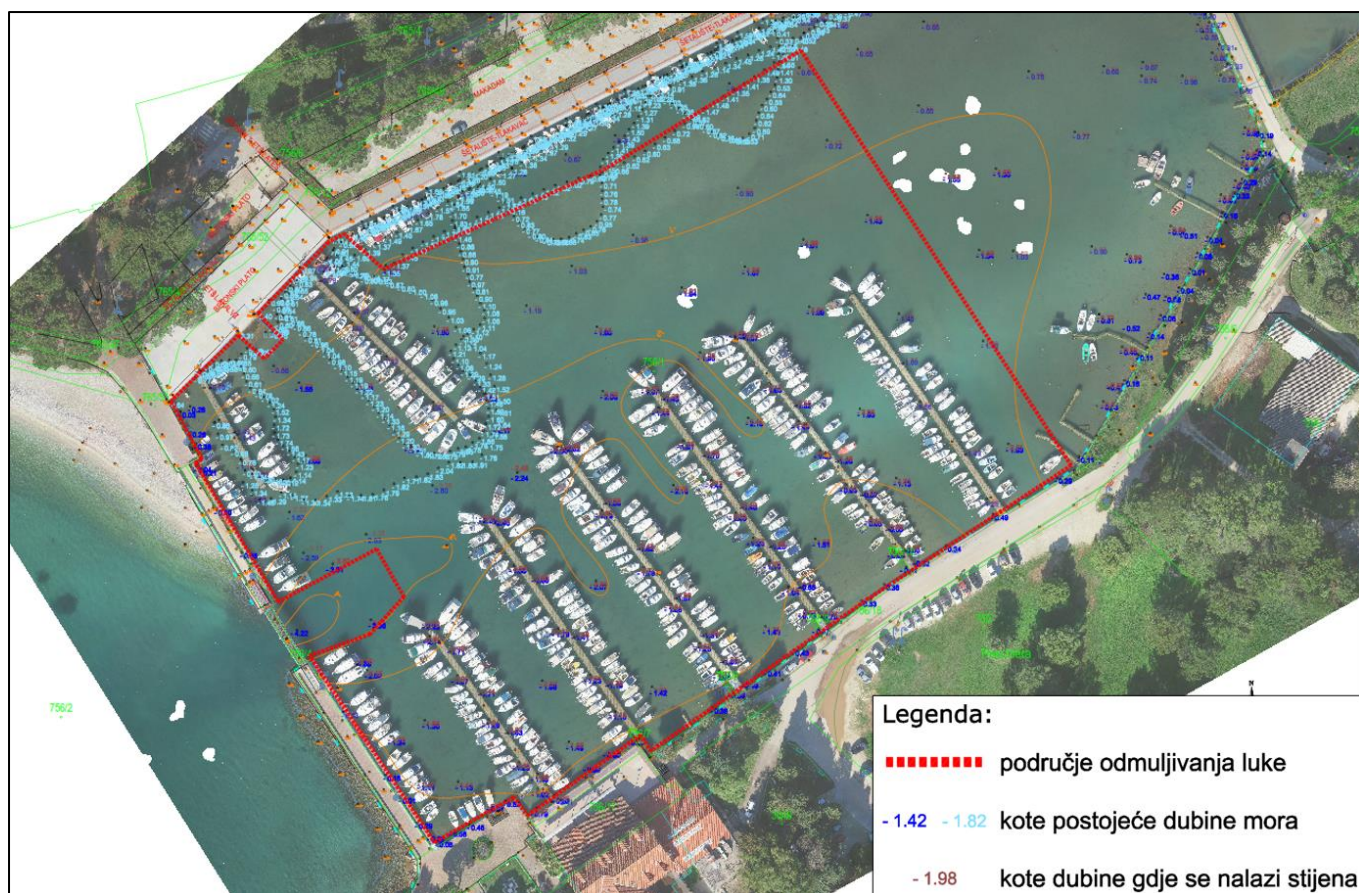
Situacija planiranog dijela luke za odmuljivanje (obuhvat zahvata označen je crvenom bojom)
